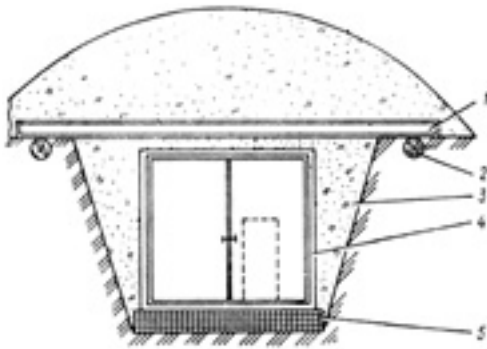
Усиление защитных свойств БВУ из железнодорожных контейнеров: 1 – несущая конструкция; 2 – продольная лага; 3 – грунтовая отсыпка; 4 – контейнер; 5 – амортизирующий материал
